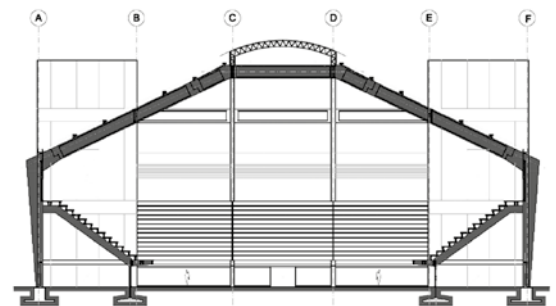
Esquema estructural de un gimnasio prefabricado
